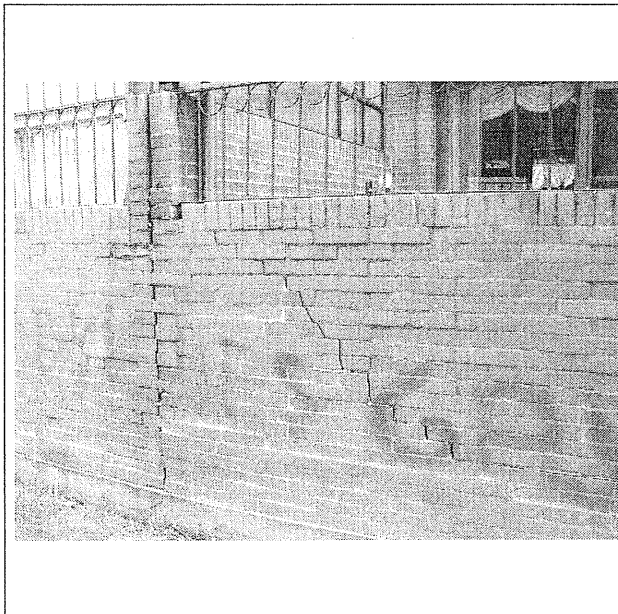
Grieta de tendencia diagonal escalonada en muro de cerramiento del costado oriental del conjunto residencial visitado.
